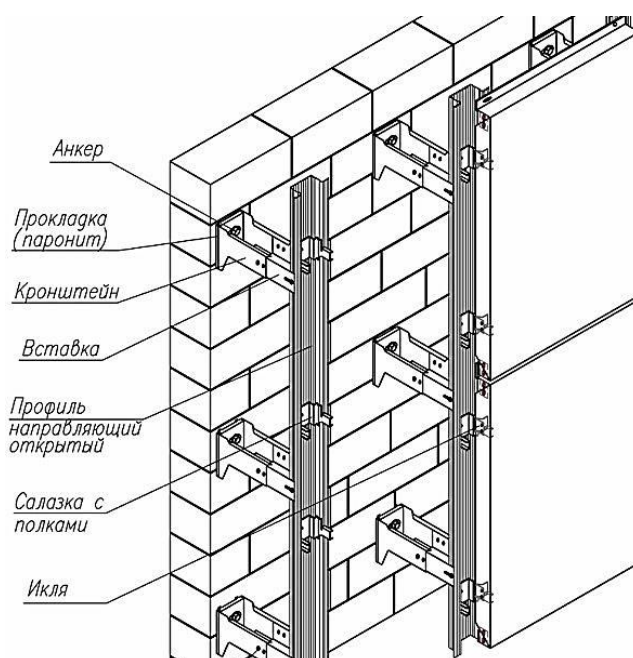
Пример конструктивной схемы монтажа навесной фасадной системы [8]
